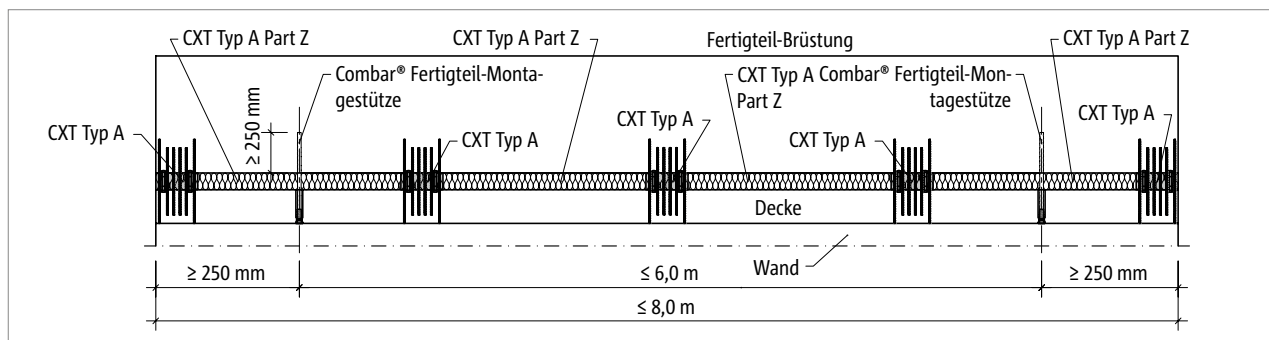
Schöck Isokorb® CXT Typ A mit Combar® Fertigteil-Montagestütze: Randabstände und Mindesteinbindelänge in der Fertigteilbrüstung
